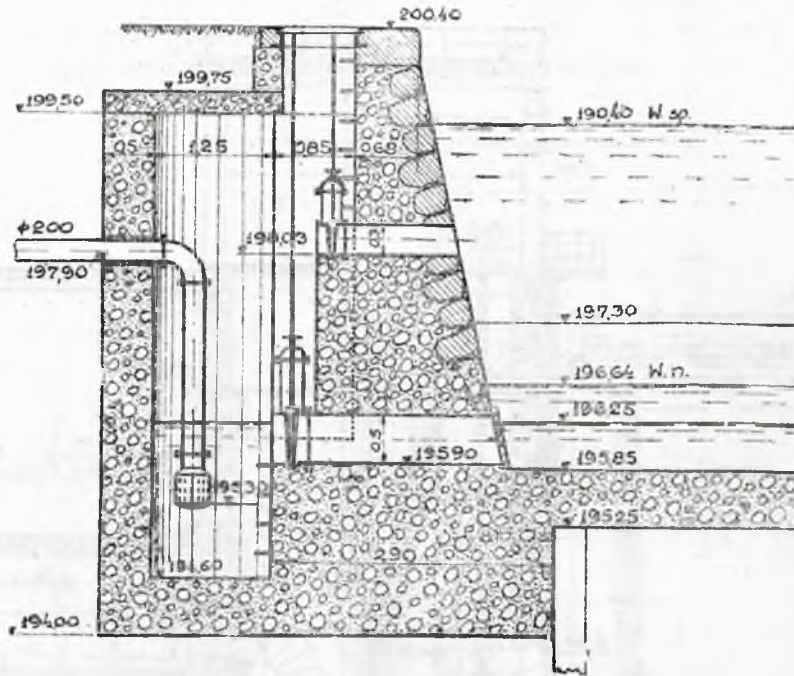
Wieża wlotowa zaopatrzona w zamknięcia, sita, smoki.
